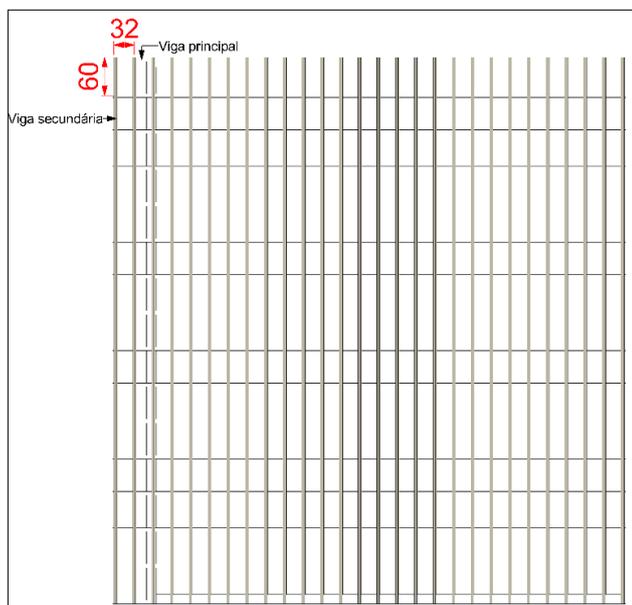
Planta de cobertura para telha cerâmica aparente.
